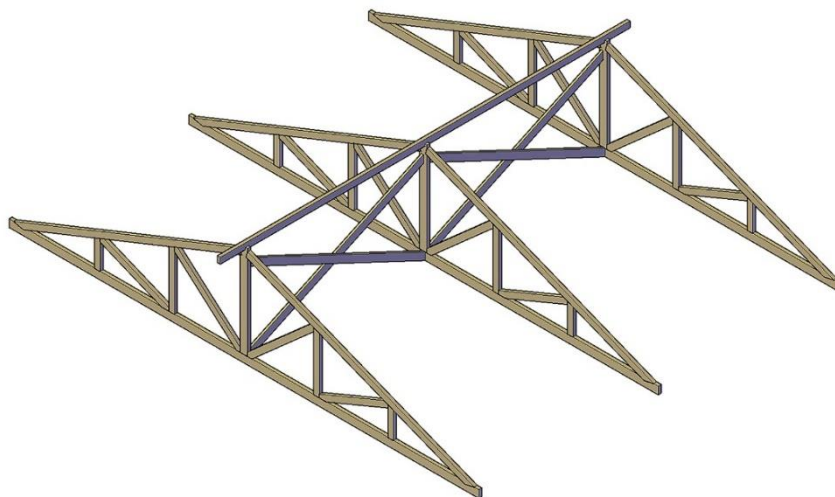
Contraventamento das tesouras por diagonais. Fonte: autor
